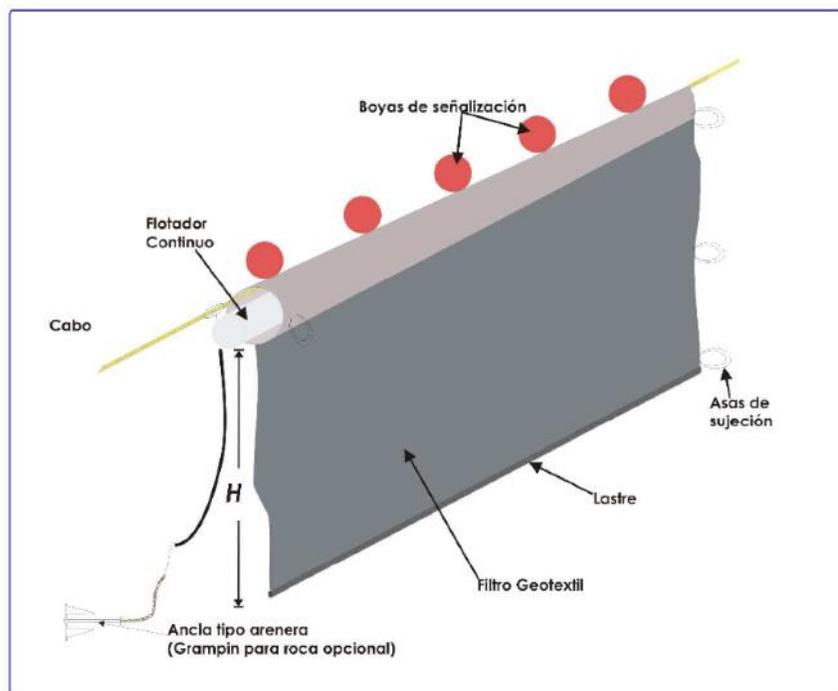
Instalación de malla geotextil para el proceso de hincado de pilotes
